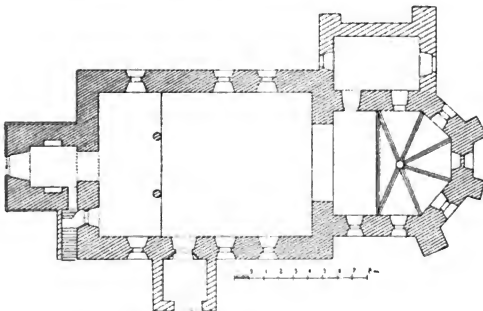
Kovačev. Grundriss der Kirche.
